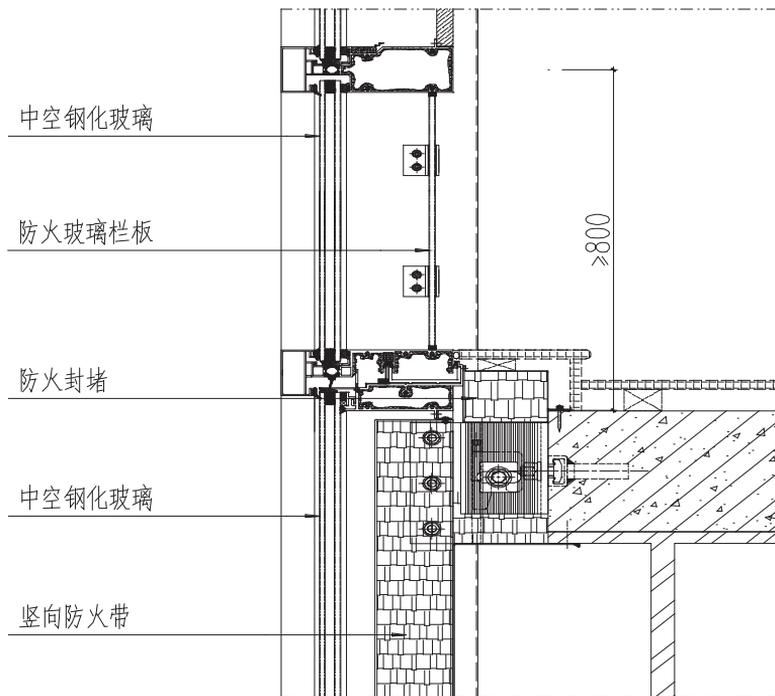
“钢结构+混凝土”结构层间防火构造示意
